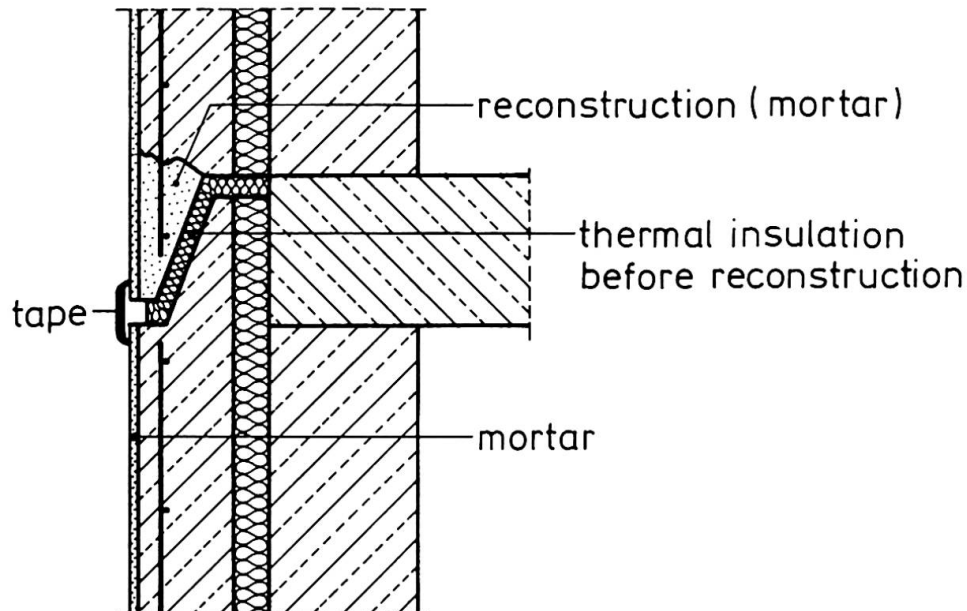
Reparatur der geschädigten Horizontalfuge durch ein Betonsanierungssystem
